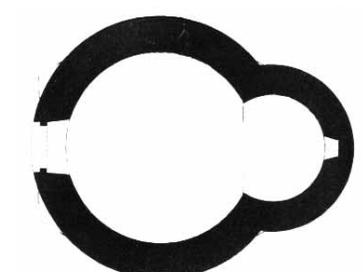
Grundriss Bruck an der Mur, M 1:200. MdkkCC 10/1865, 193.
